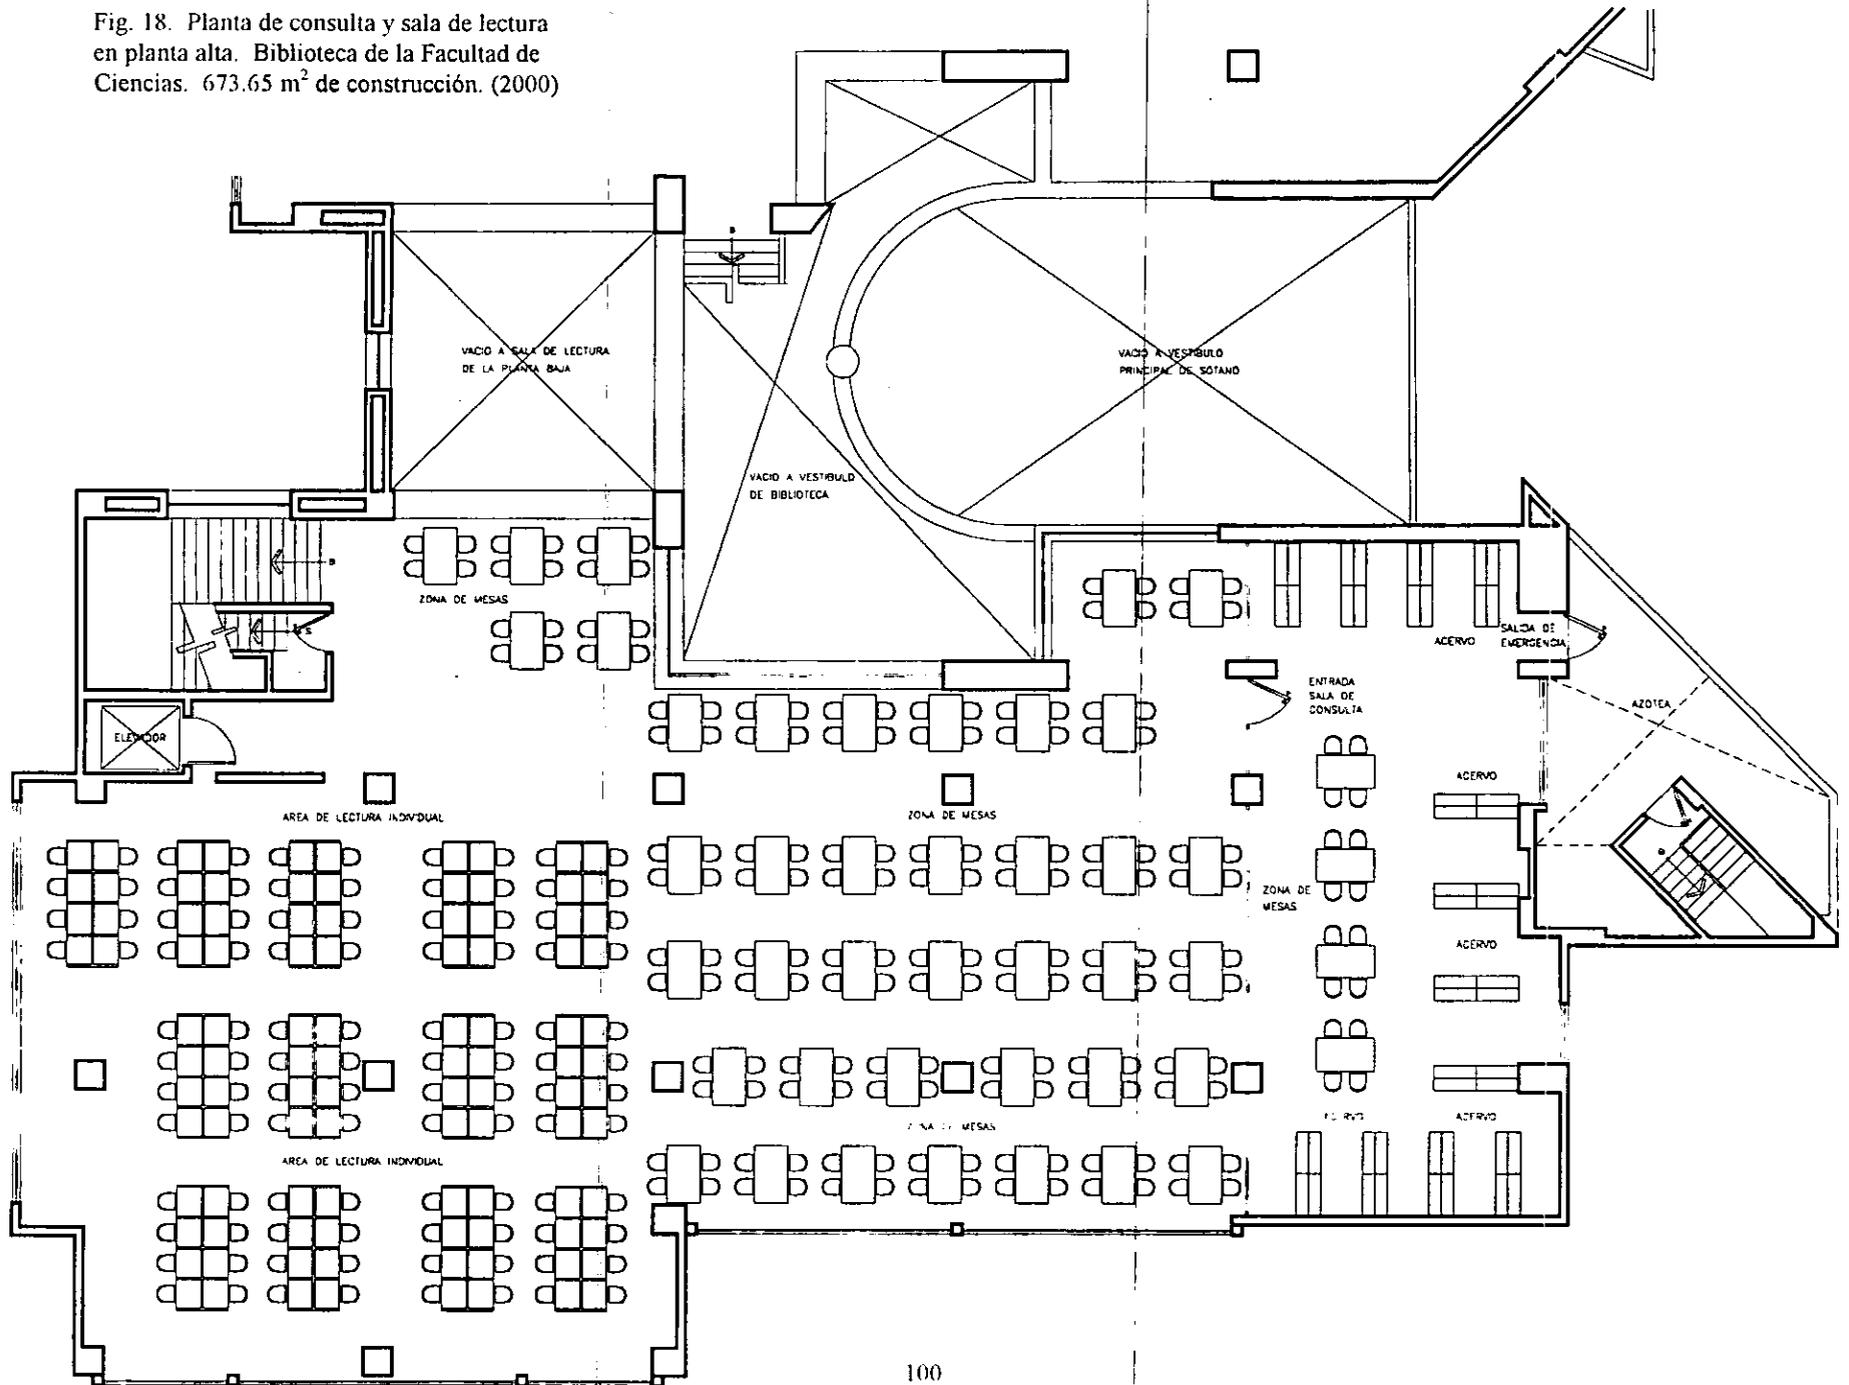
Planta de consulta y sala de lectura en planta alta. Biblioteca de la Facultad de Ciencias. 673.65 m² de construcción. (2000)
